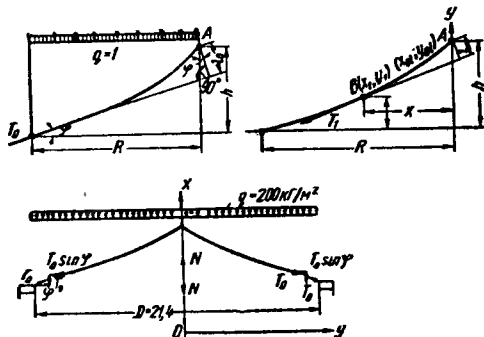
Расчетные схемы висячей кровли резервуара емкостью 5000 м³
